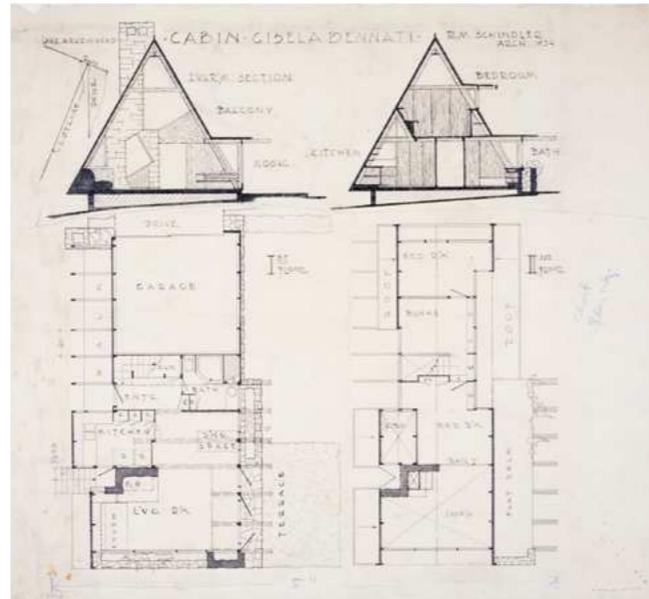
, Originalzeichnung R. M. Schindler, Bennati Haus
